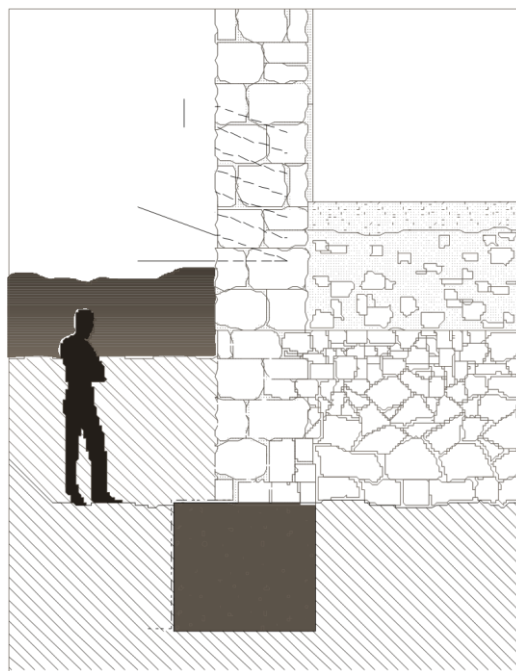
Detalle del replanteo de las boquillas de inyección.
